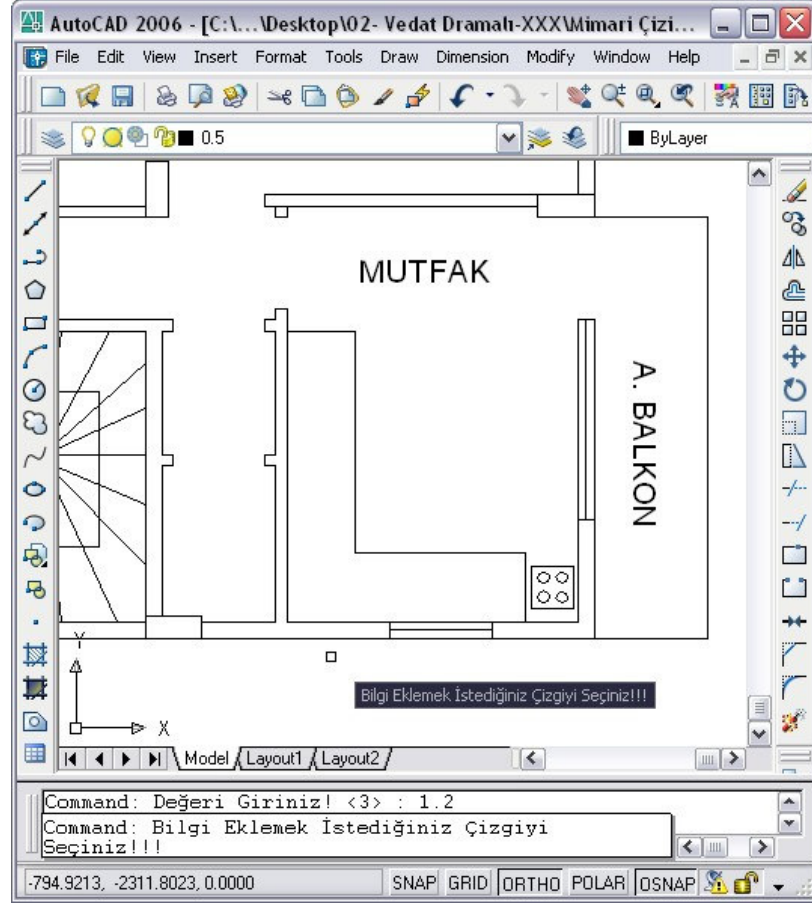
Autocad komut satırında pencere adet girişi ekran görüntüsü
